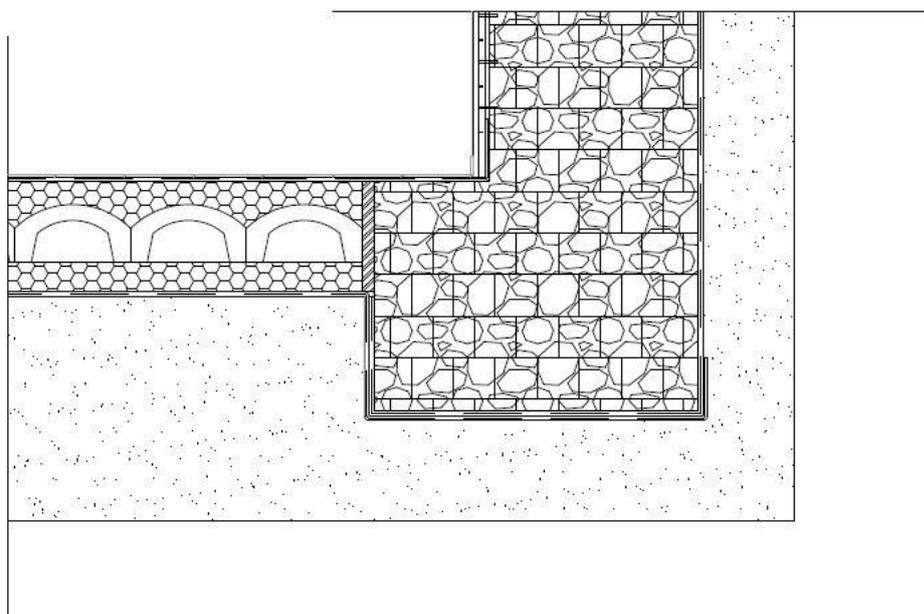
Detalle de cimentación. Fuente: Elaboración propia.
